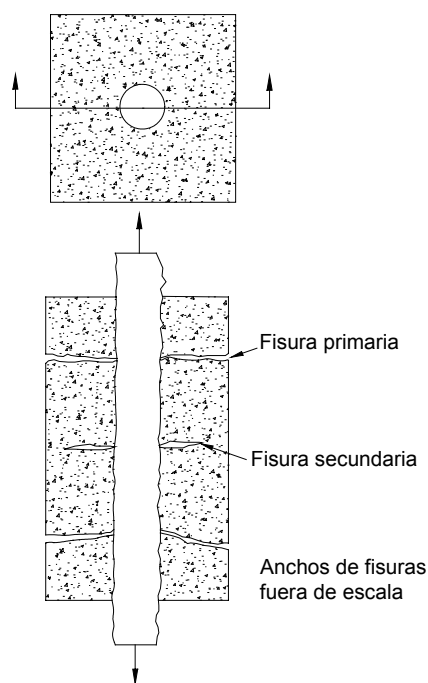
Fisuras primarias y secundarias en un miembro de hormigón armado traccionado
